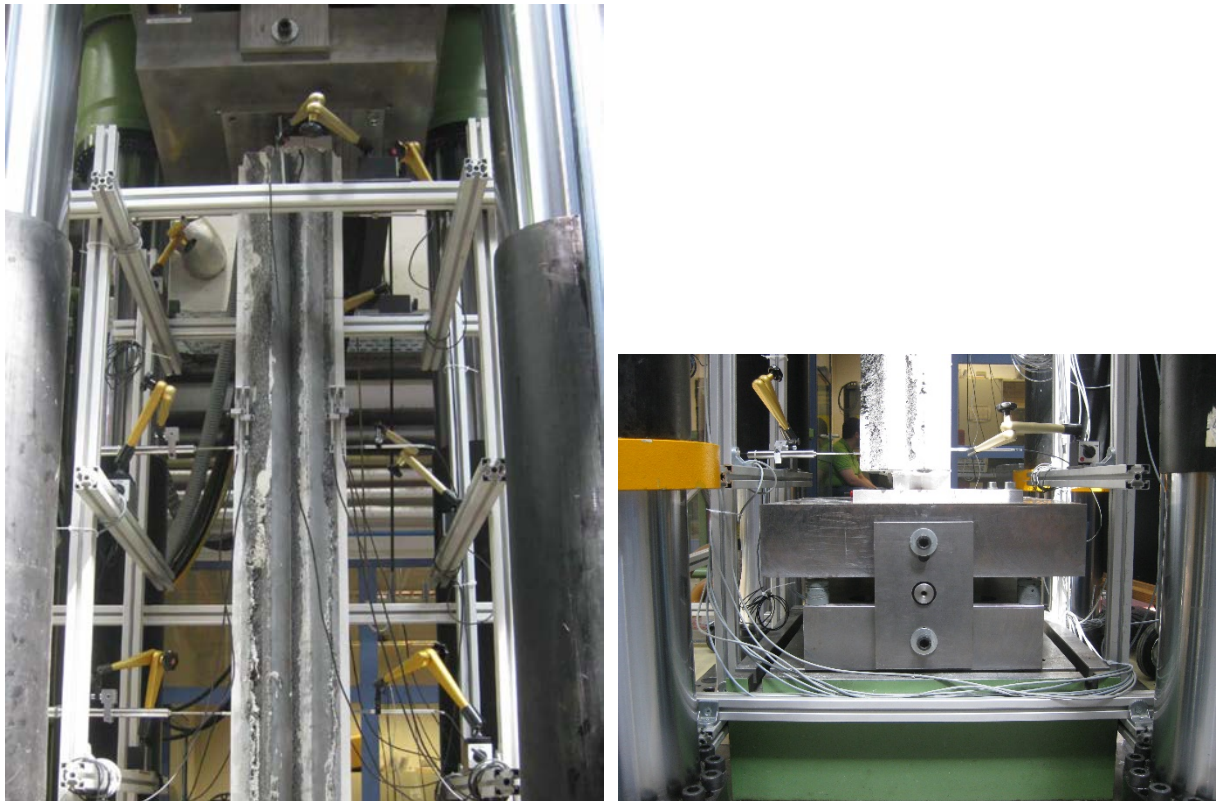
Obere Stirnflächenansicht (links) und Fußpunktlagerung (rechts)
